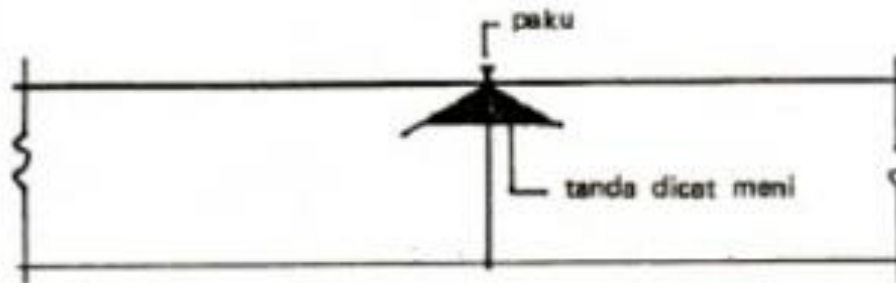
, Pemasangan Bowplank di Sekeliling Bangunan
